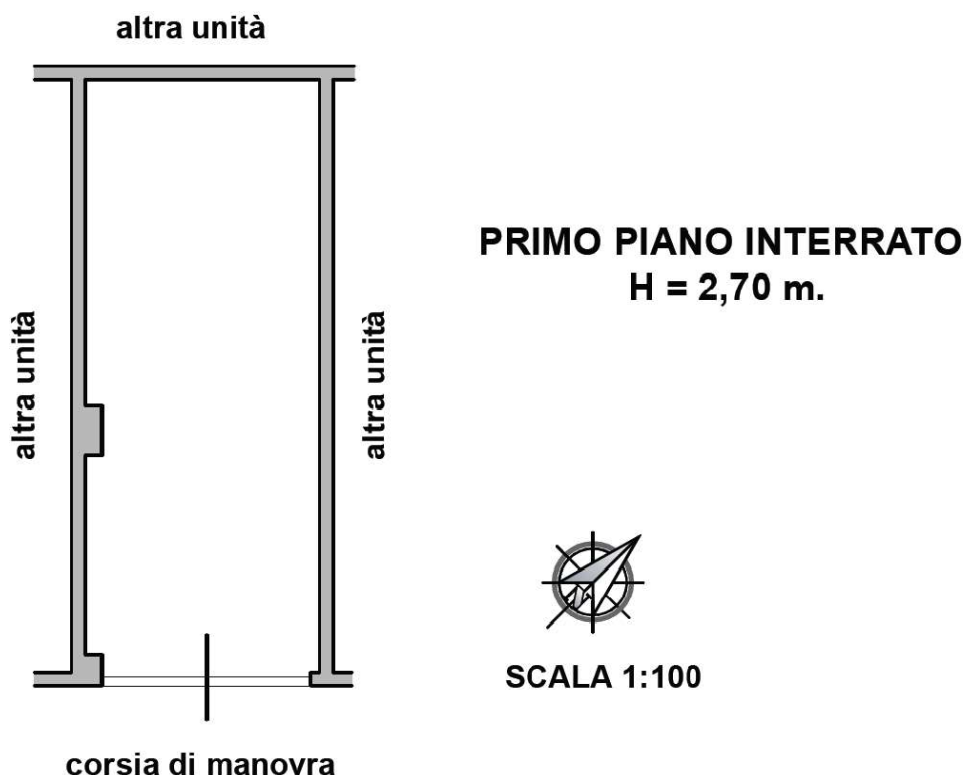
LOTTO 10 – Planimetria box auto foglio 76 – part. 620 – sub. 162
